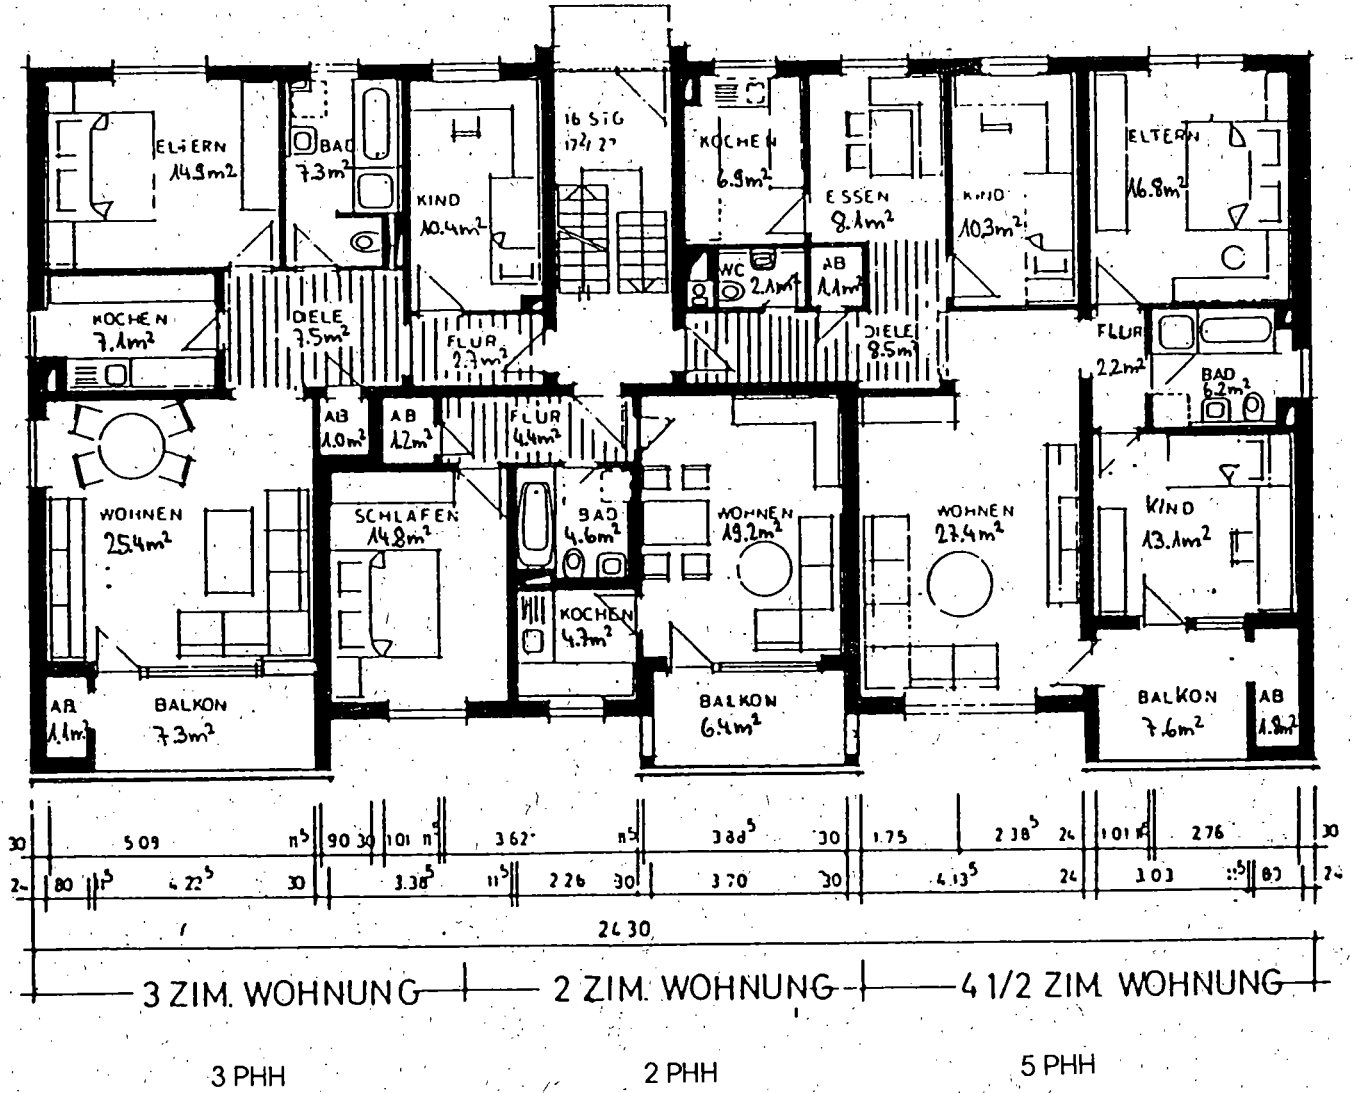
Grundriss Erdgeschoss, 1.- und 2. Obergeschoss Mühlengasse 3, Allensbach (D)
